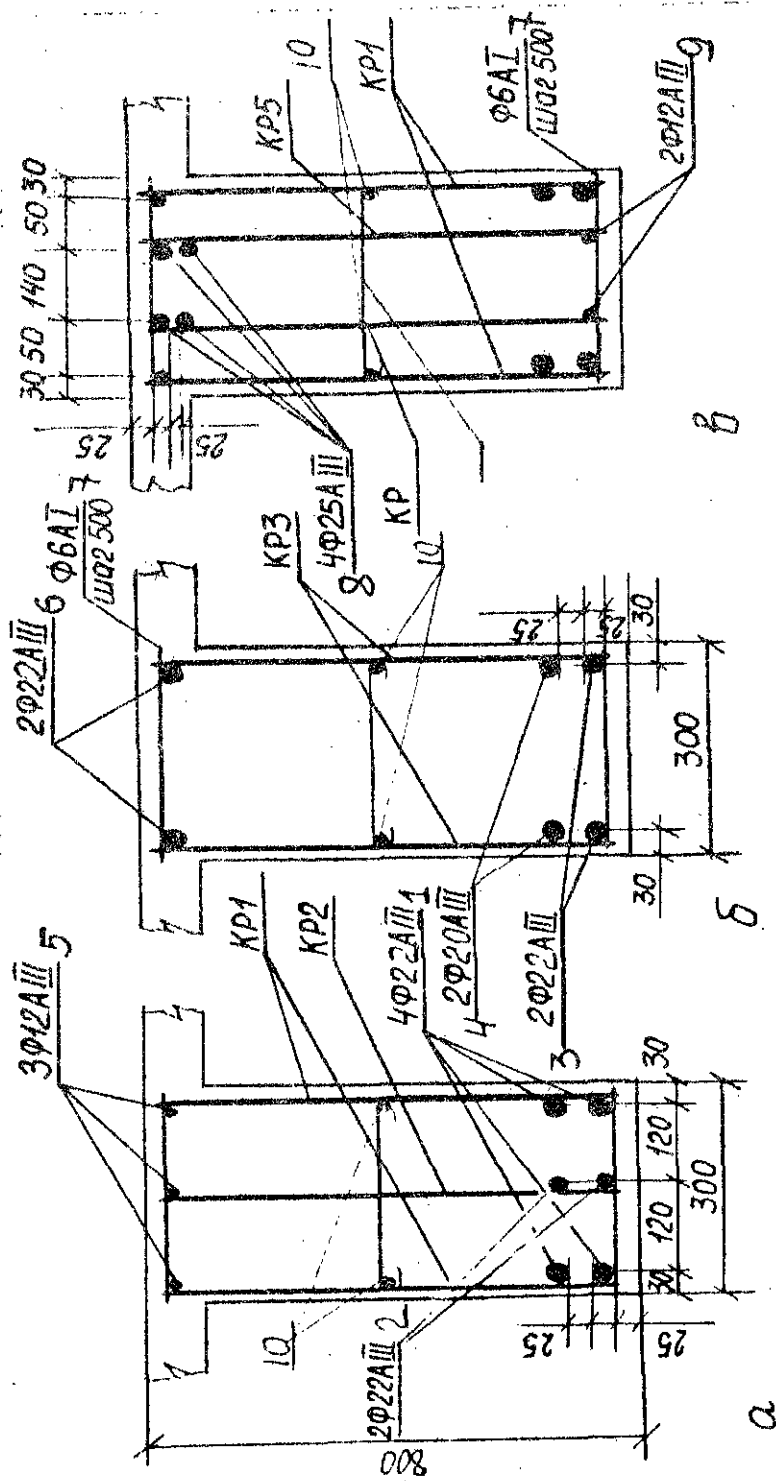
Армирование сечений балки: а - в крайних пролетах; б - в среднем пролете; в - на опорах б и с
